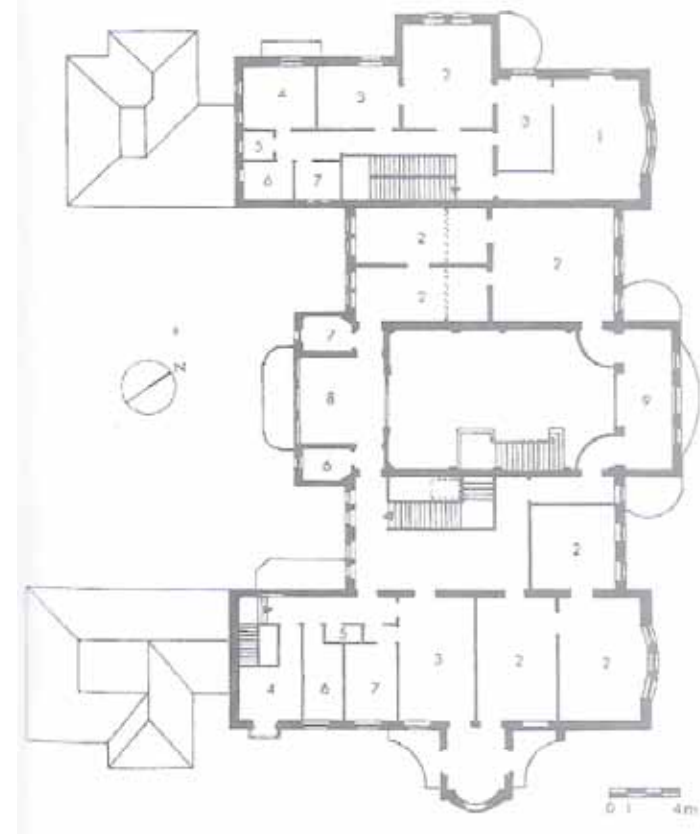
Planta do pavimento superior. Fonte: HOMEM, 2010, p.191
